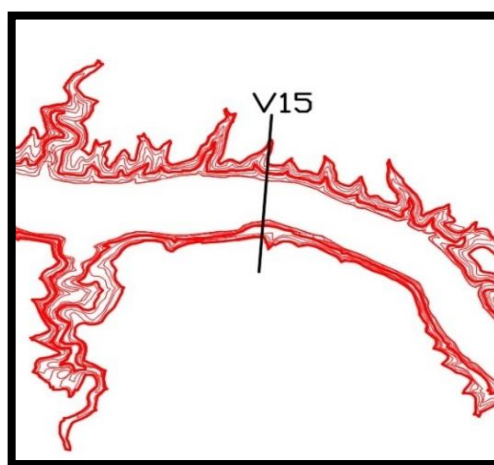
Localização perfil V15 na altimetria. Vista Civil 3D.
